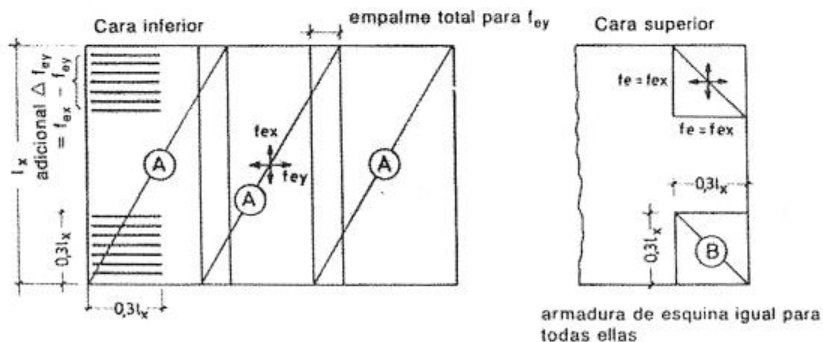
Armado de una losa rectangular simplemente apoyada con carga uniforme. (Fuente: Moller, 2010)
